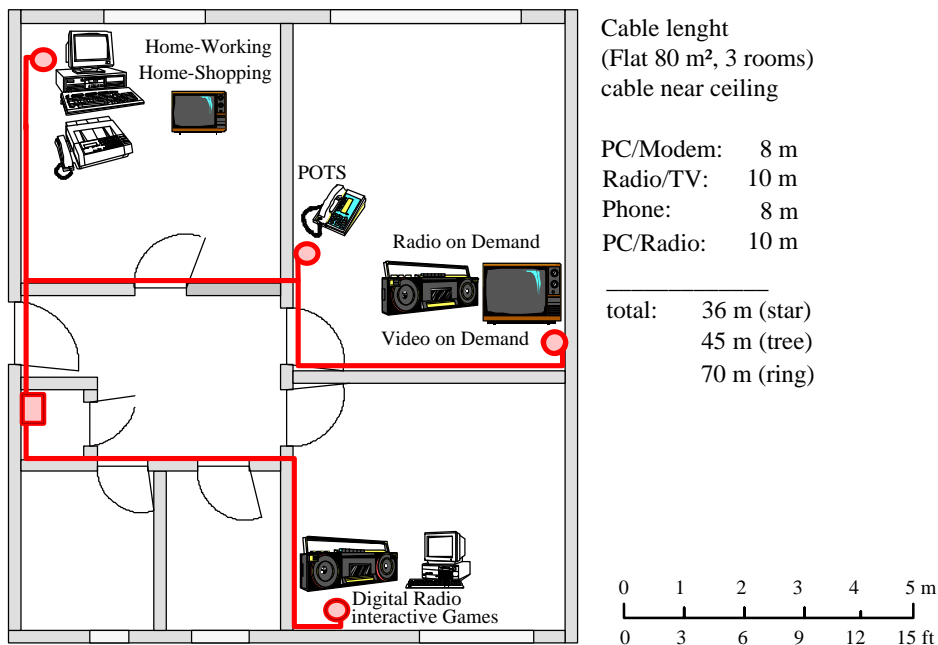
mögliche Struktur einer Gebäudeverkabelung
